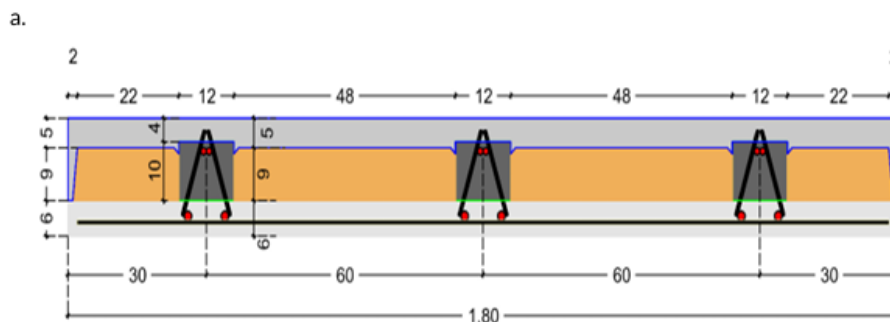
Coupe du plancher dalle BB. Portées de 0 à 6m50 épaisseur dalle BB : 15 cm.
